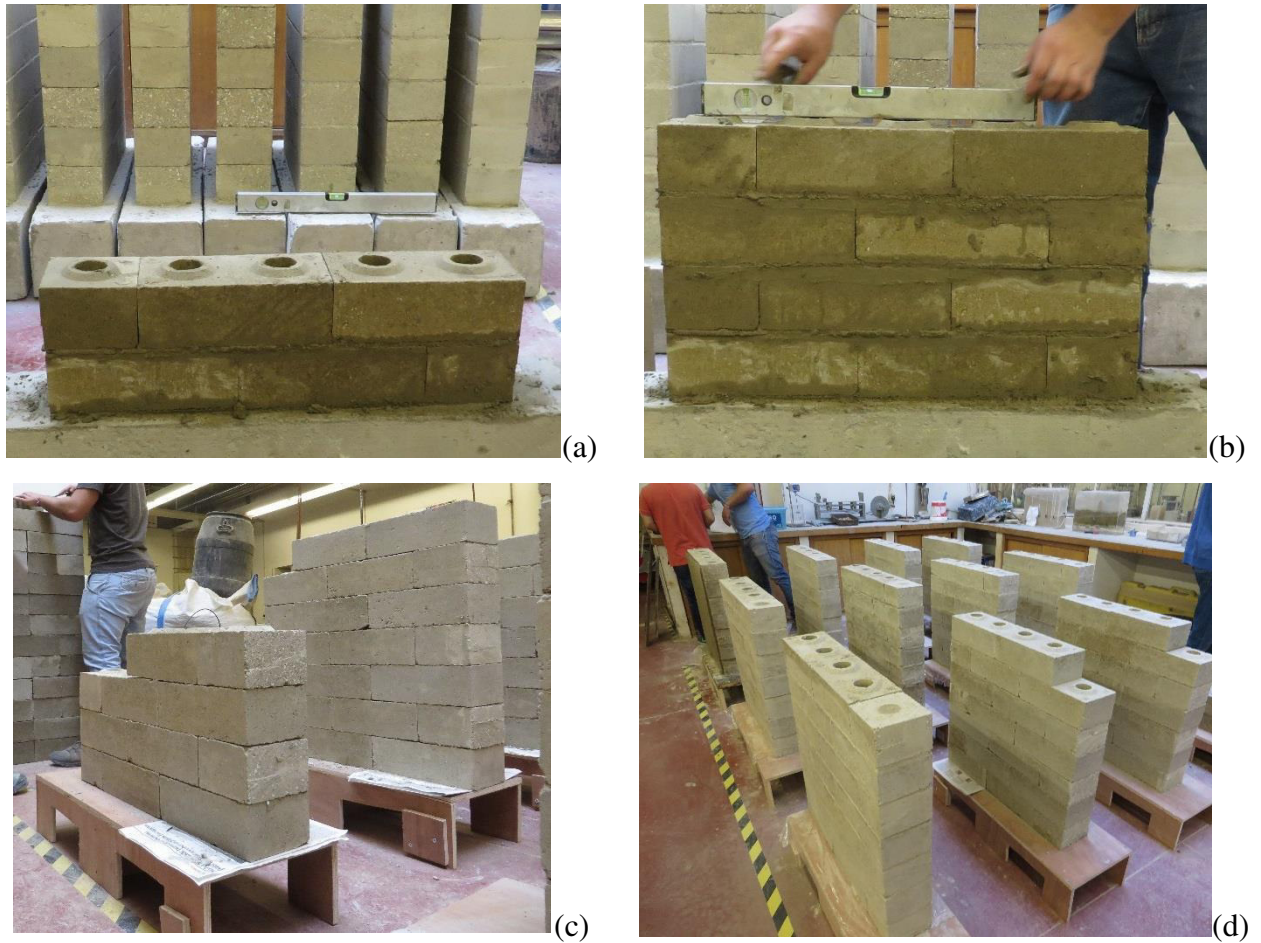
Processo de construção das paredes: (a) Construção de paredes de junta argamassada; (b) verificação do nivelamento da parede; (c) construção de parede de alvenaria; (d) colocação dos reforços nos cantos;
